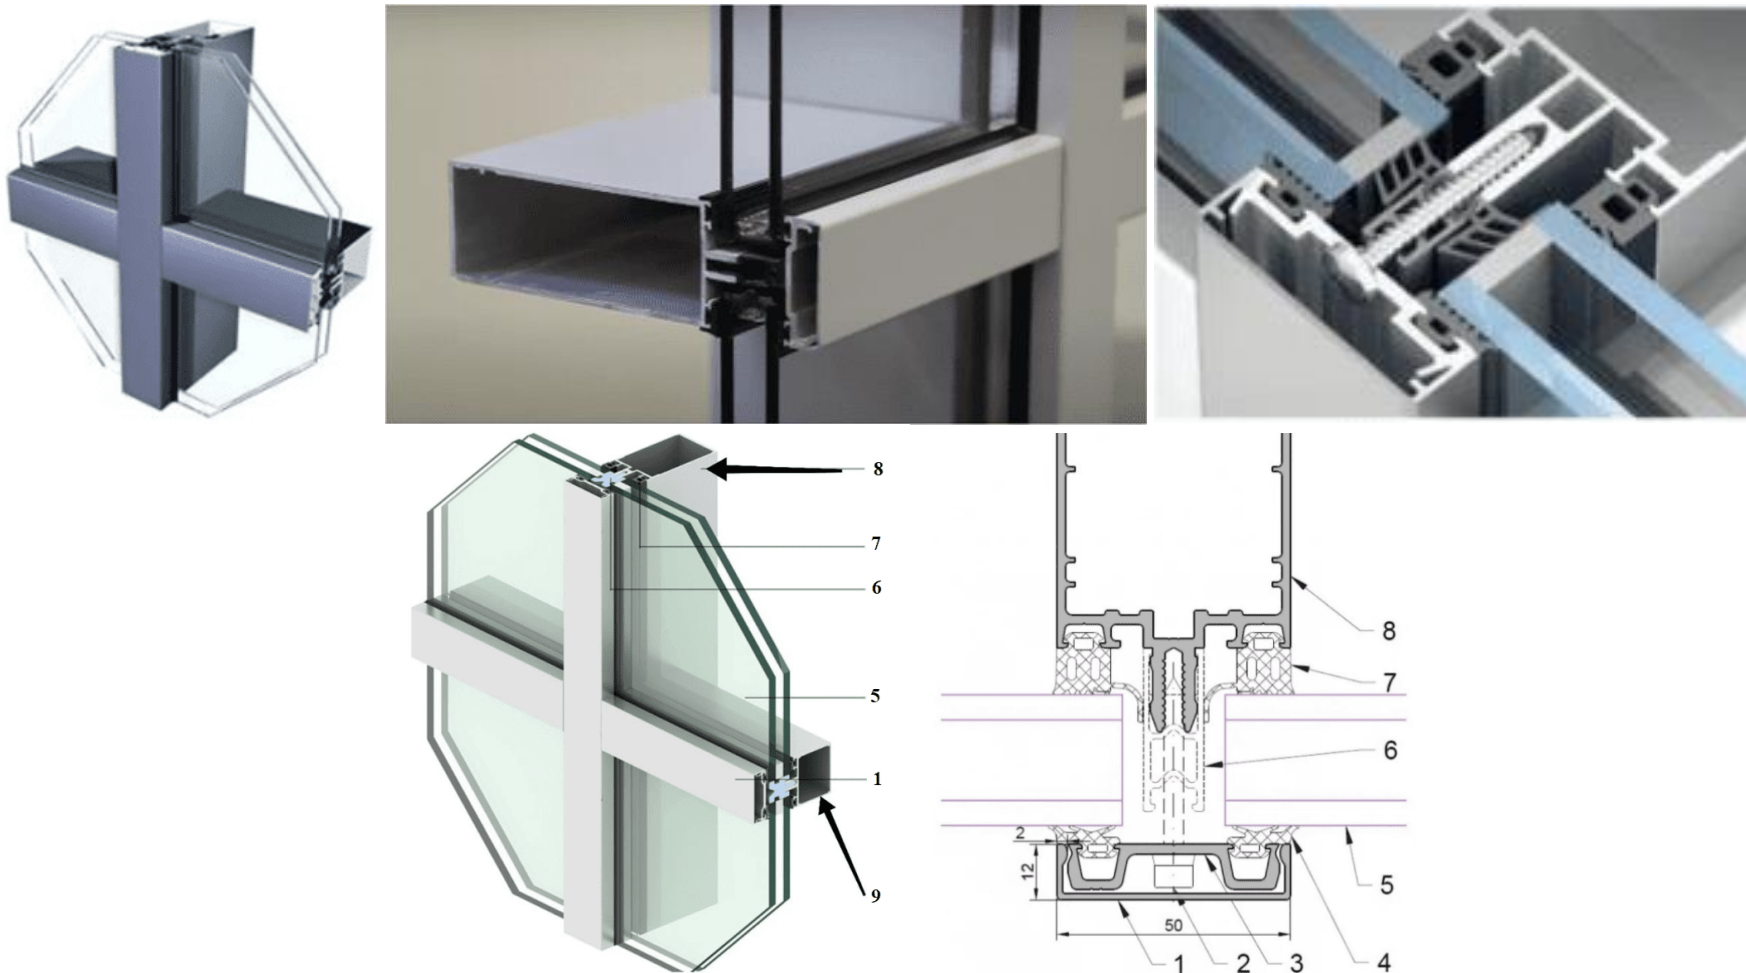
Стоечно-ригельное остекление фасадов
